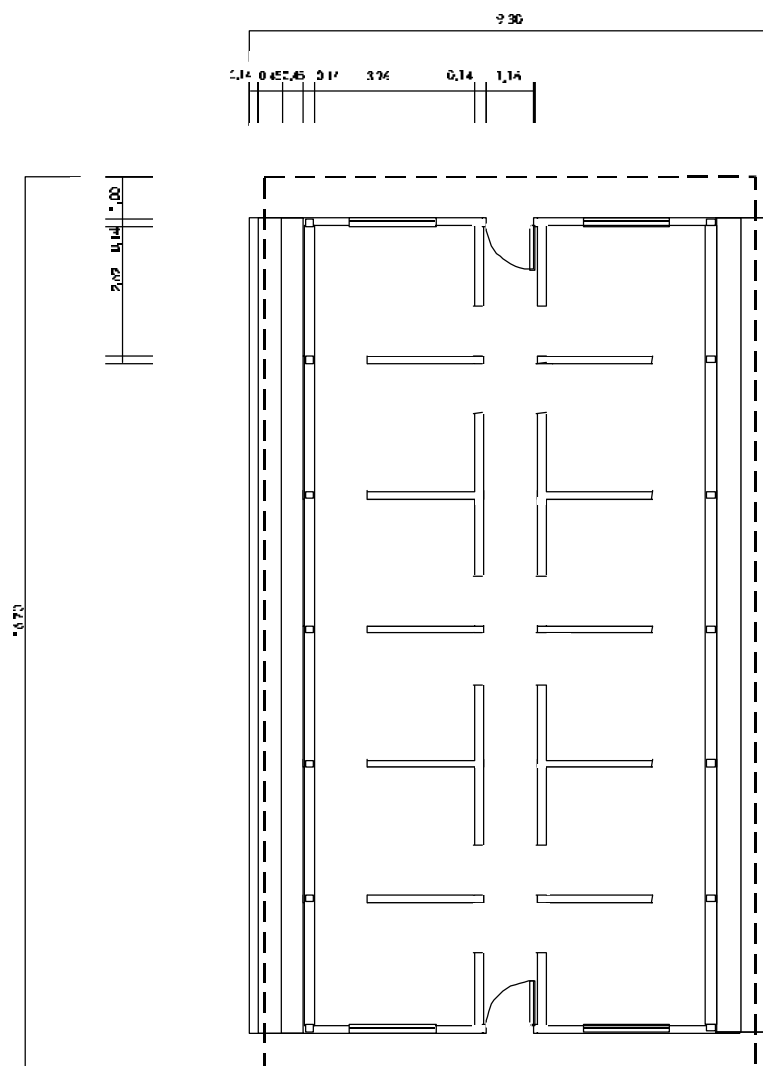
Planta baixa do galpão crescimento e terminação. S/escala. Dimensões em metros.
